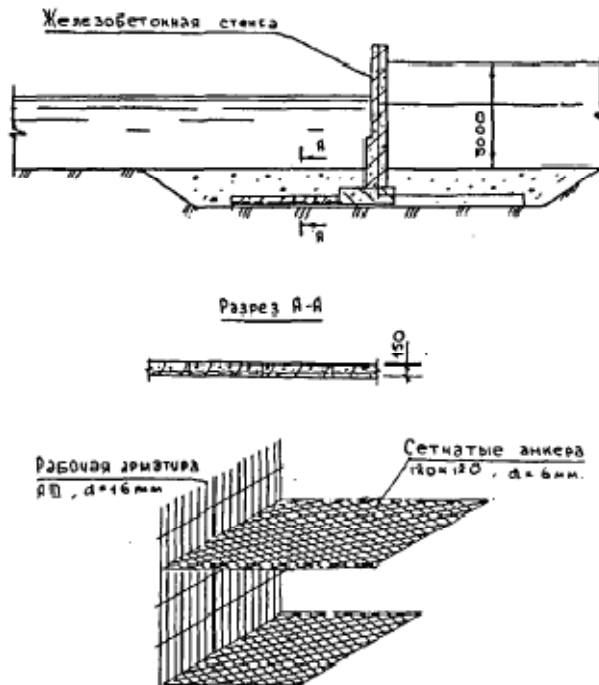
Бетонная подпорная стенка с сетчатыми анкерами (вариант 6)
